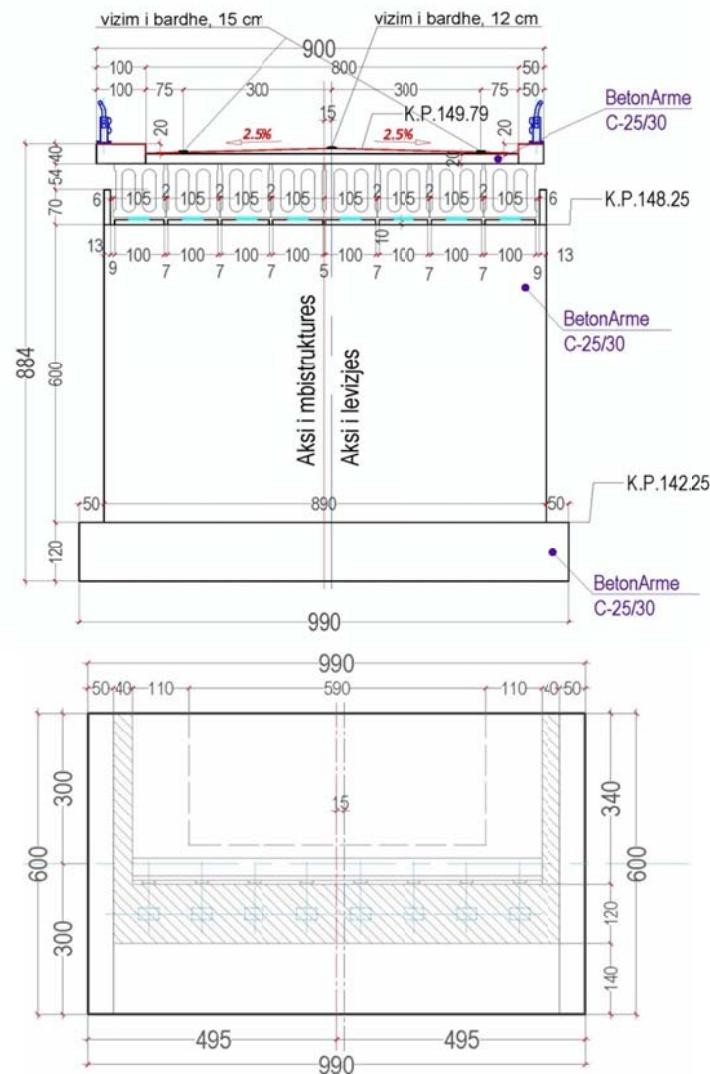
Prerja tërthore e ballit dhe planimetria e themelit te poshtëm te ballit 1 dhe 2
